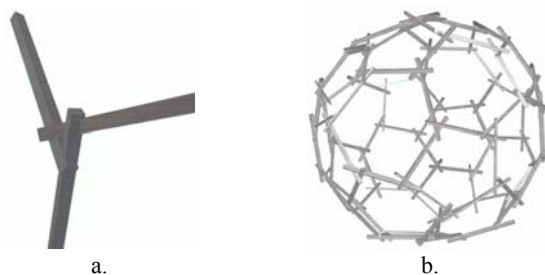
Structura spațială sferică cu bare libere din lemn:
